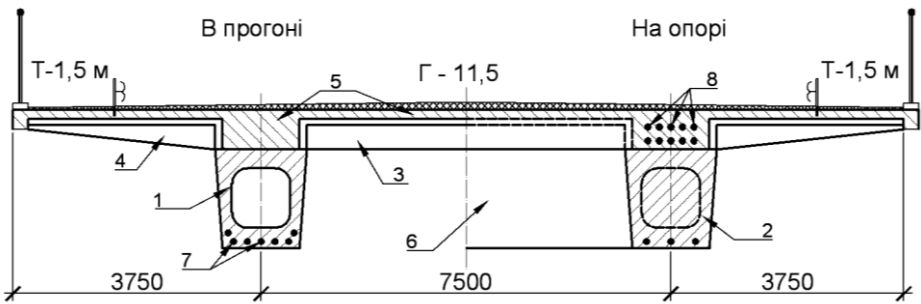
Двобалкова нерозрізна збірно-монолітна залізобетонна прогонова будова моста для складних умов будівництва: 1 - збірна прогонова балка; 2 - монолітна або збірна надопорна балка; 3 - збірна ребриста плита; 4 - збірна ребриста консольна плита; 5 – бетон замоноличування головних балок і плити; 6 – монолітна діафрагма в стиках і над опорами; 7 – напружувана арматура збірних балок; 8 – напружувана арматура в надопорних зонах і стиках
